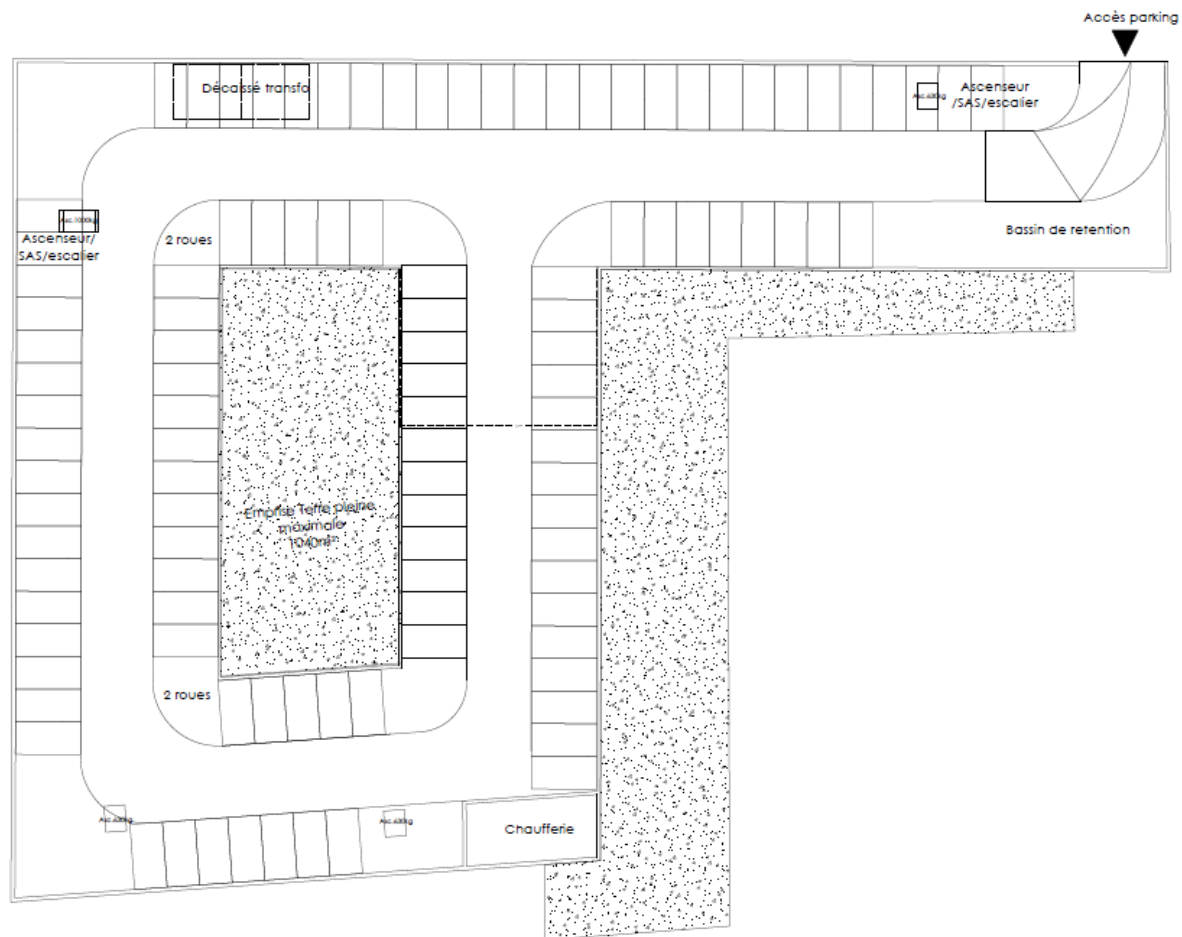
Plan masse (source : Wilmotte et Associés SA, 09/09/2019)
